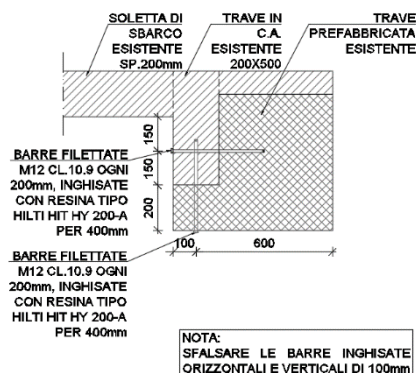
Collegamento soletta di sbarco delle scale - trave di bordo
